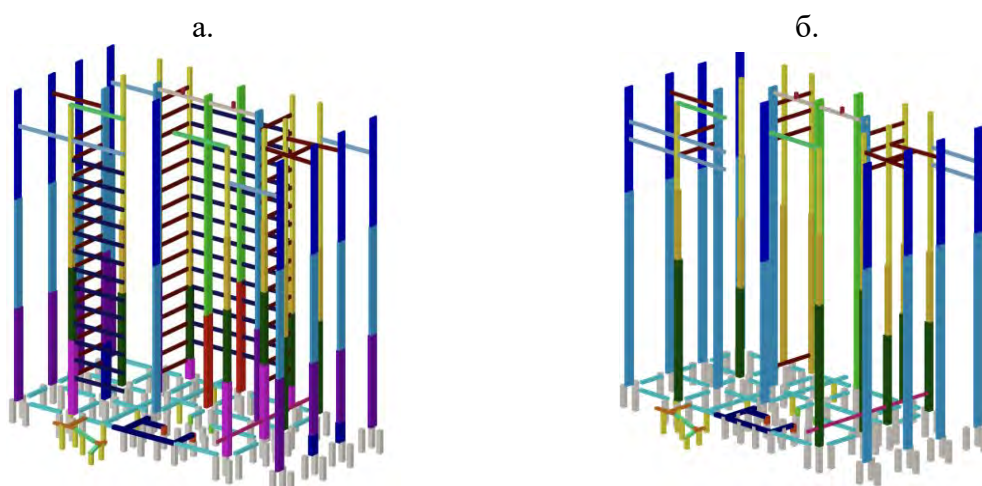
Уменьшение сечения колонн и количества балок в железобетонном каркасе:
